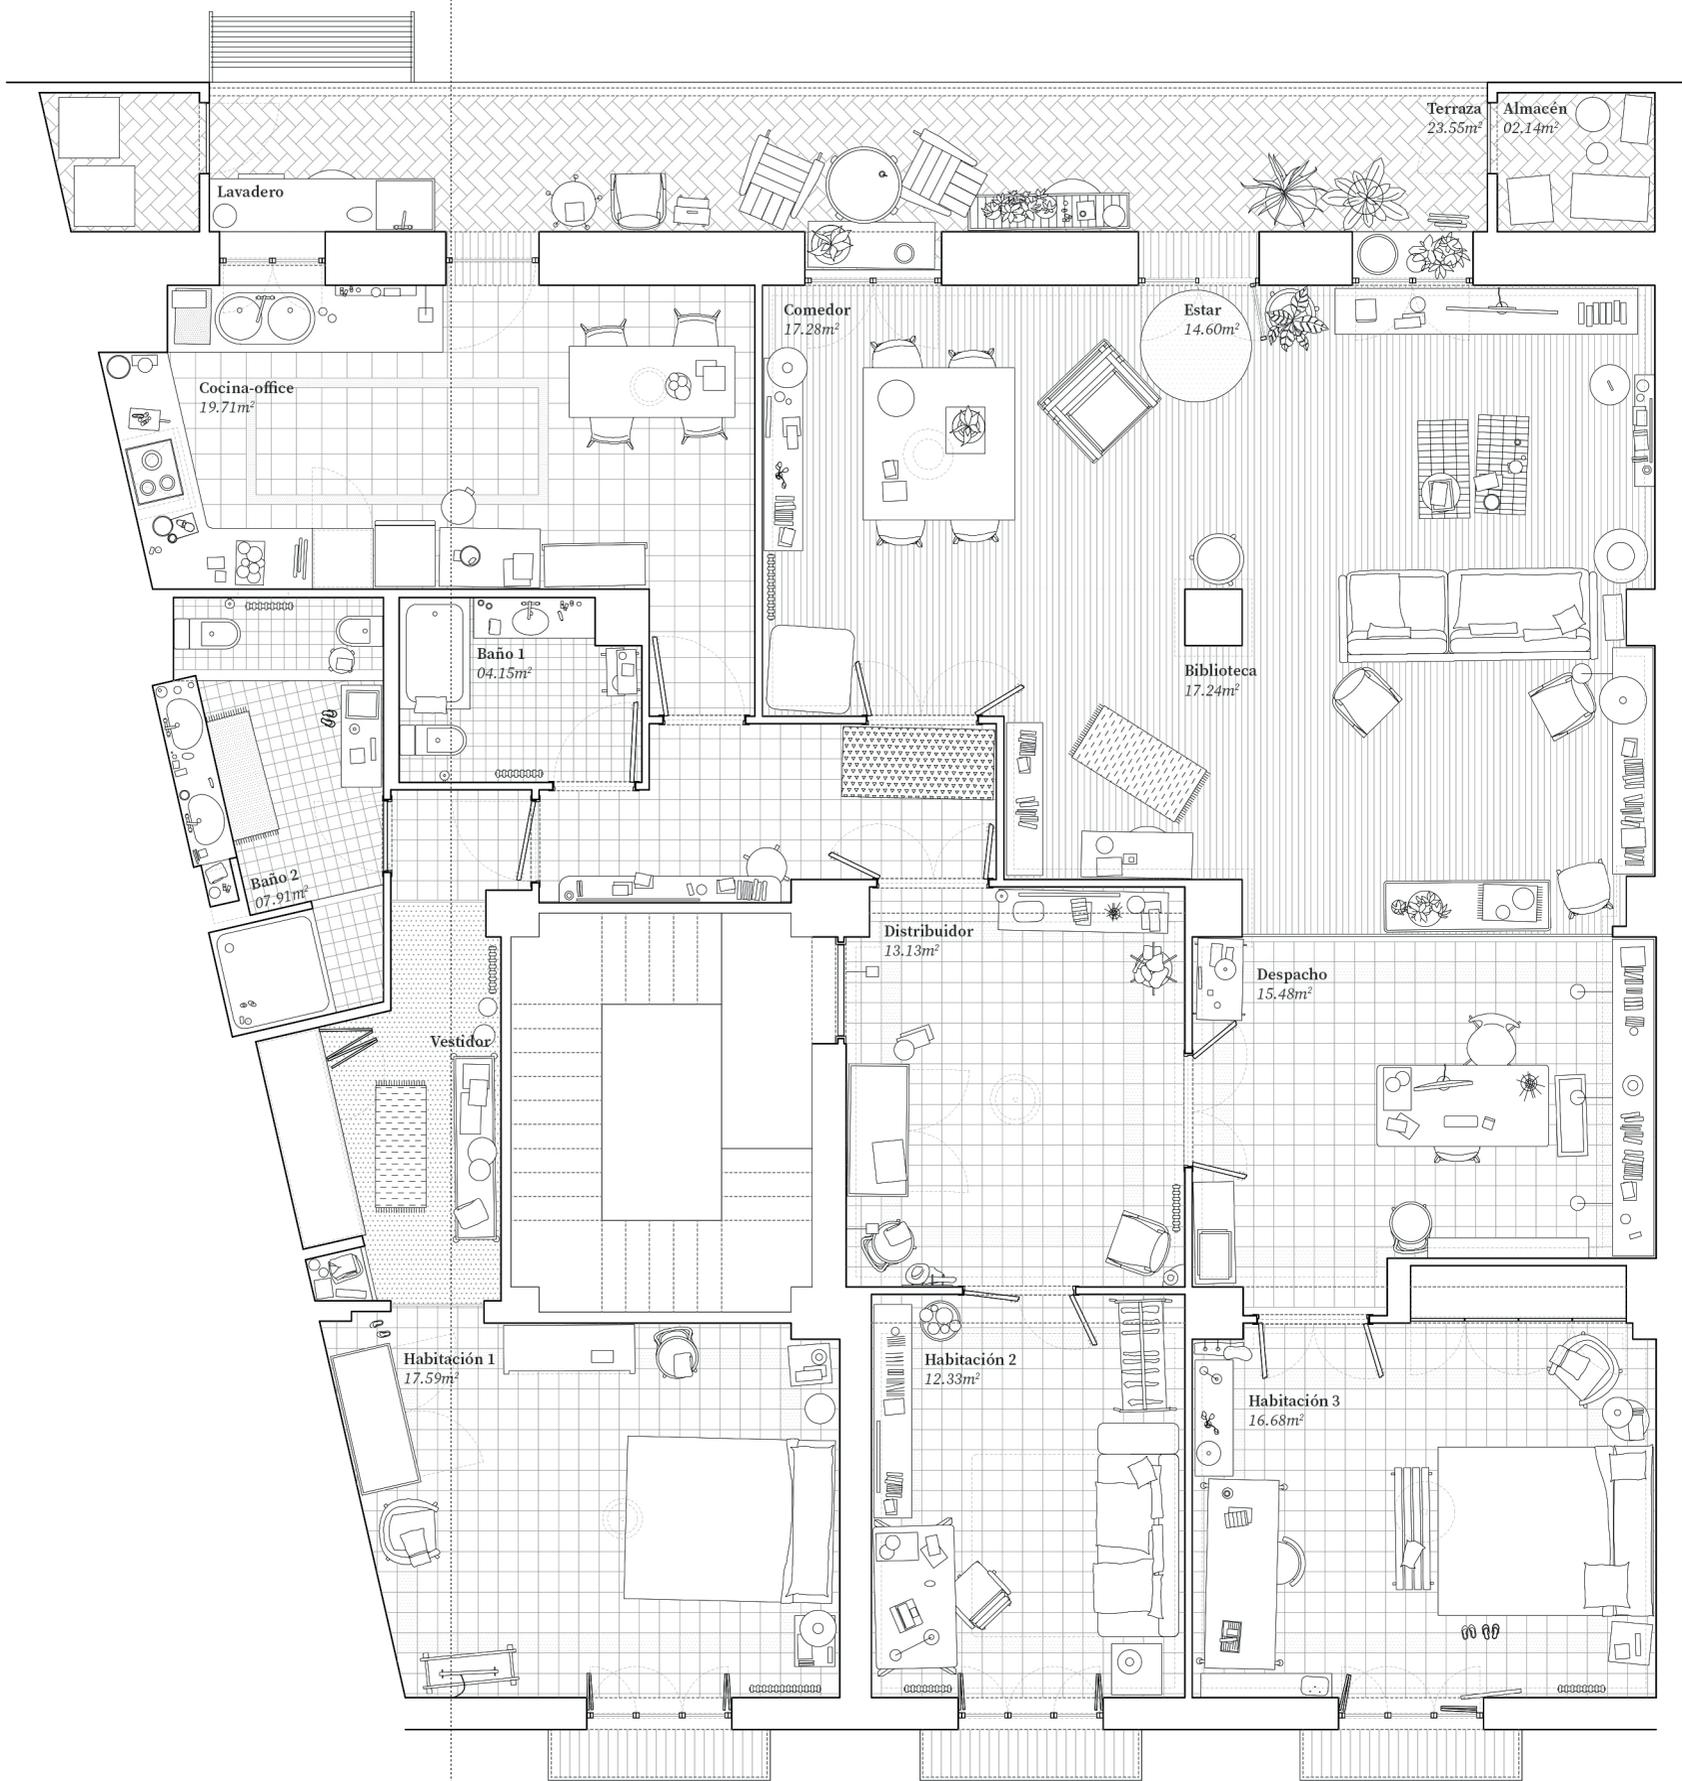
Planta de la vivienda del proyecto de Criado. Escala 1:75. Fuente: elaboración propia.
